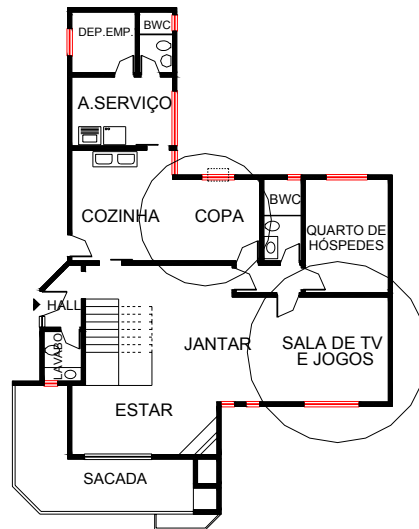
Planta Baixa do apartamento 802 - Estudo de caso C (Apartamento Triplex).
